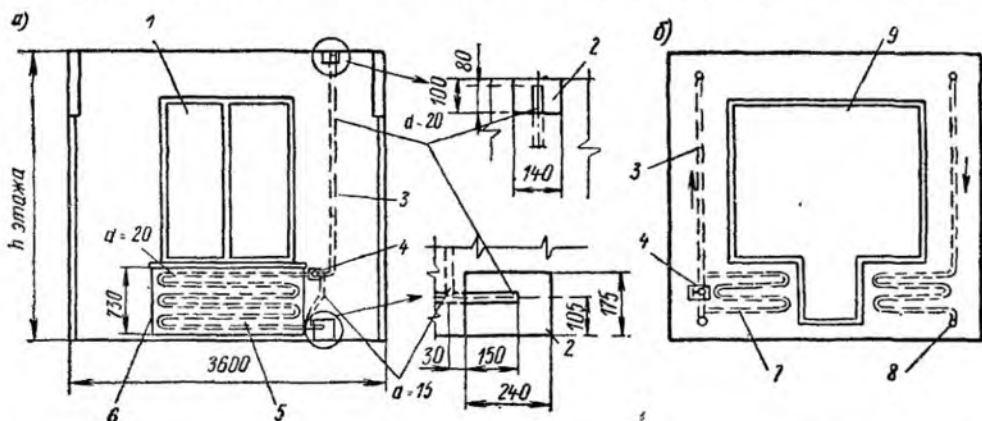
Наружные стены с отопительными стояками и подоконными бетонными панелями
